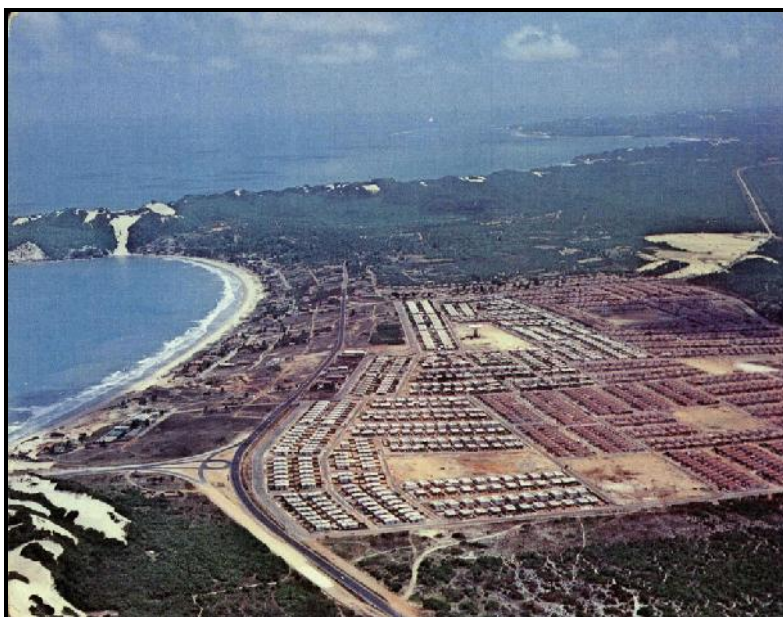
Construção do Conjunto Habitacional Ponta Negra
